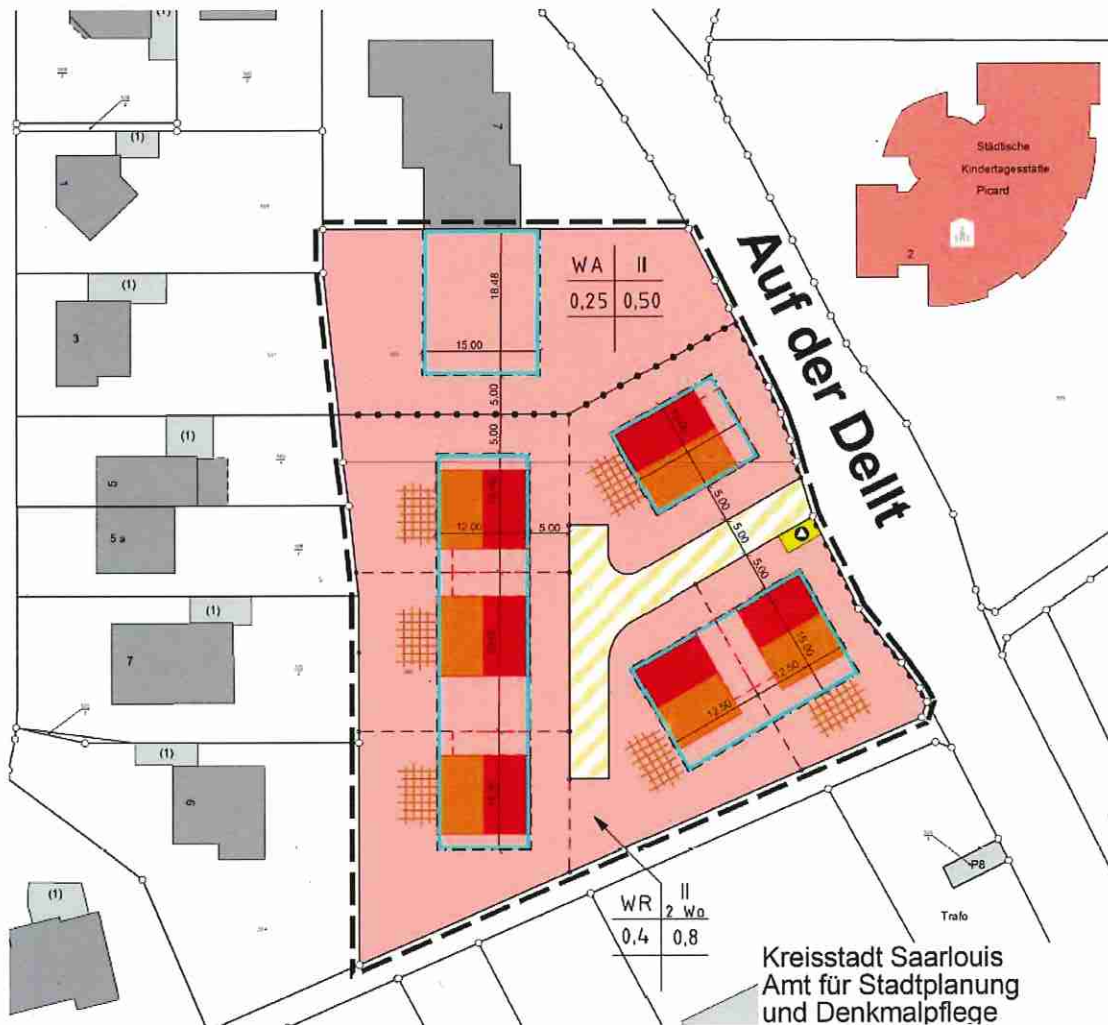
Planzeichnung mit Gestaltungsvorschlag
